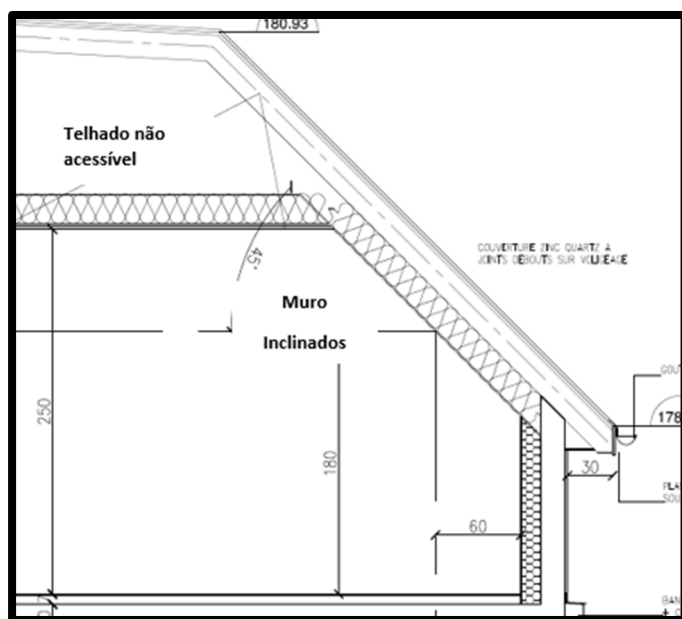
Detalhe representativo telhado não acessível e muro inclinado
